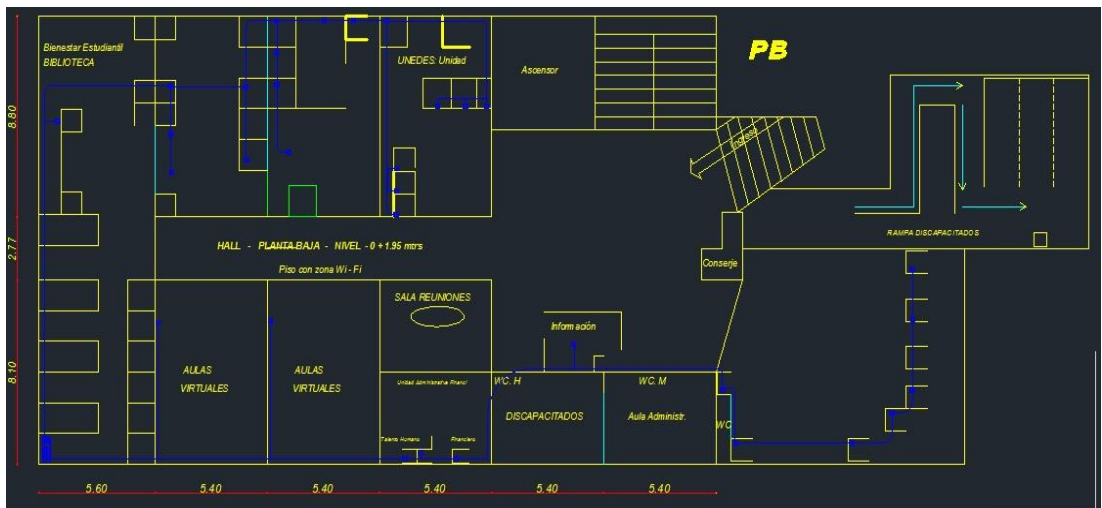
Diseño de la red actual de la Planta Baja.
